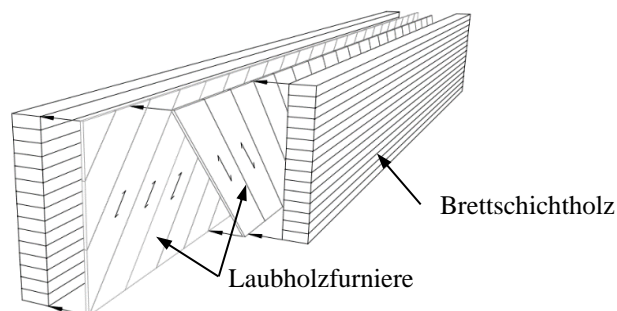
Prinzipieller Aufbau von holzbewehrtem Holz mit gegenläufiger Furnieranordnung
